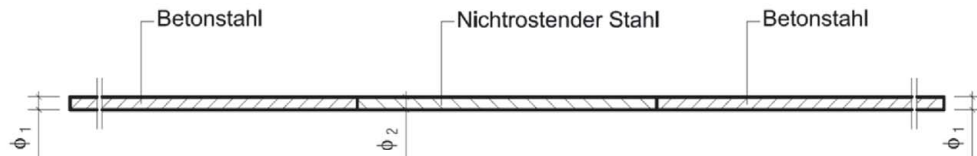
Druckelement aus Stahl mit beidseitig angeschweißtem Betonstahl
